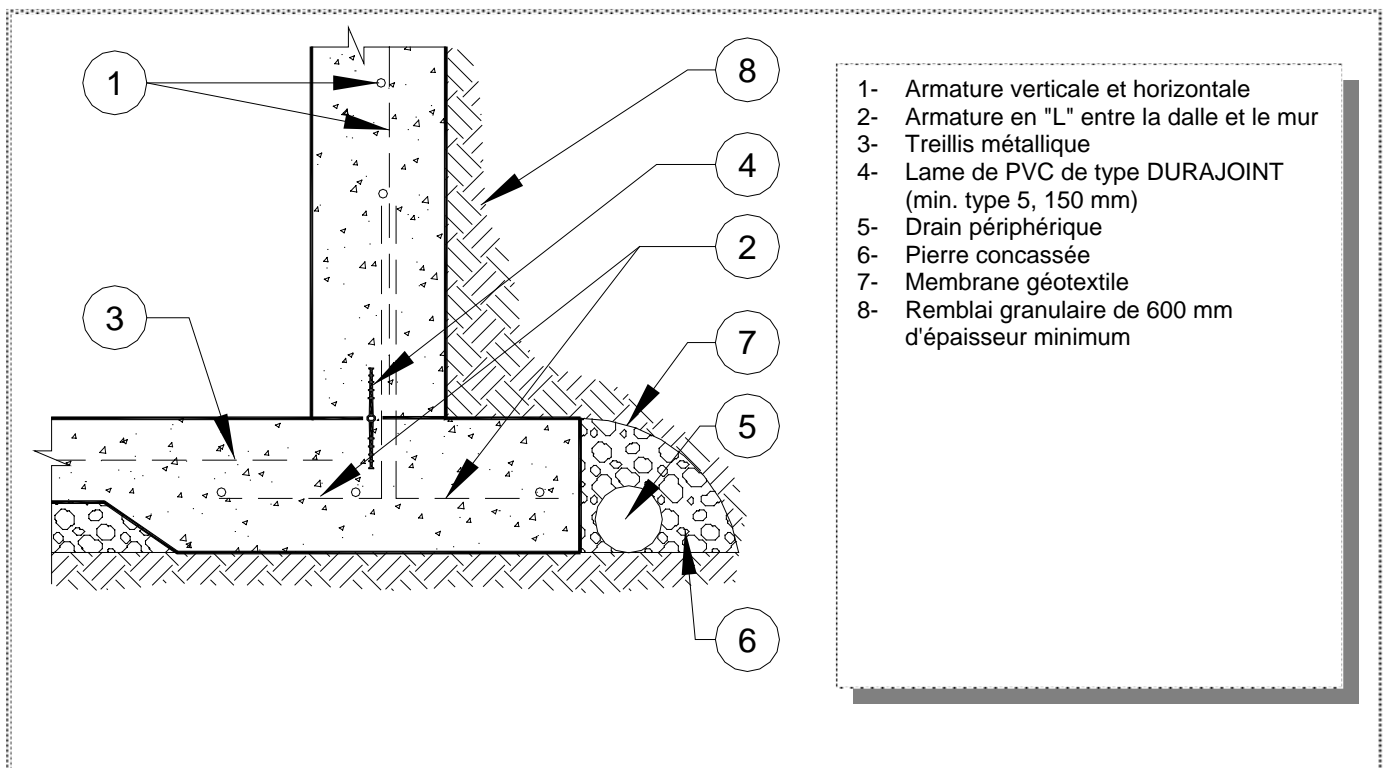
Étanchéité entre la dalle et le mur (Joint de construction)
